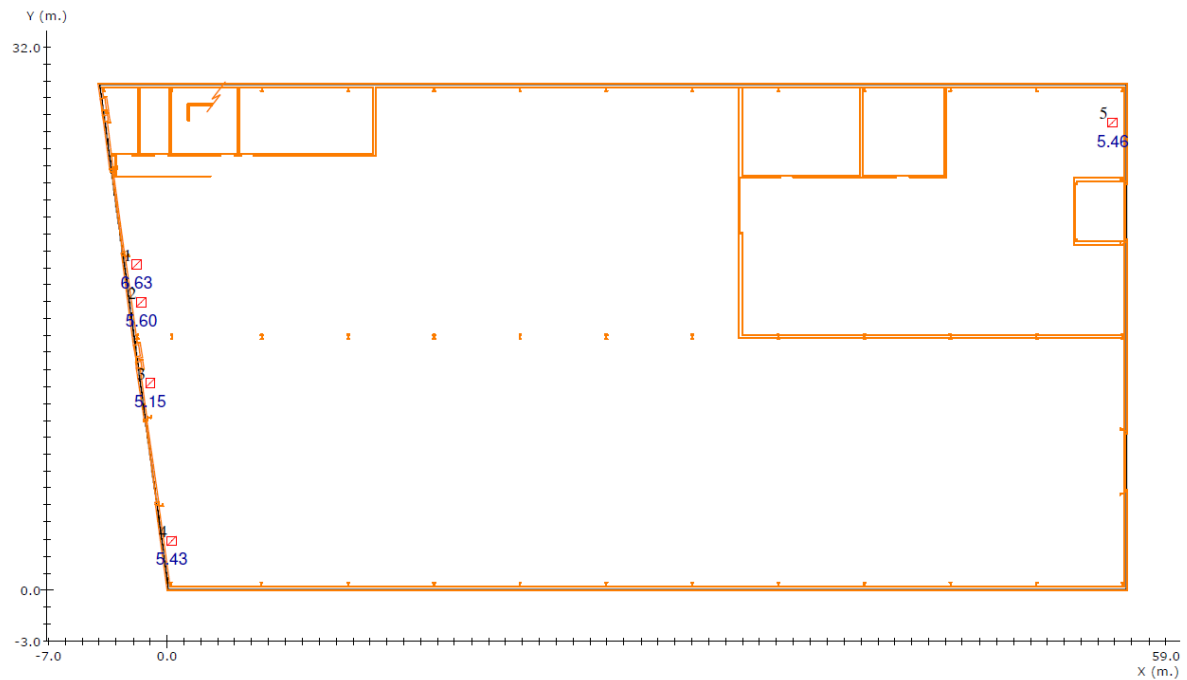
Situación de los cuadros eléctricos (Planta baja).
